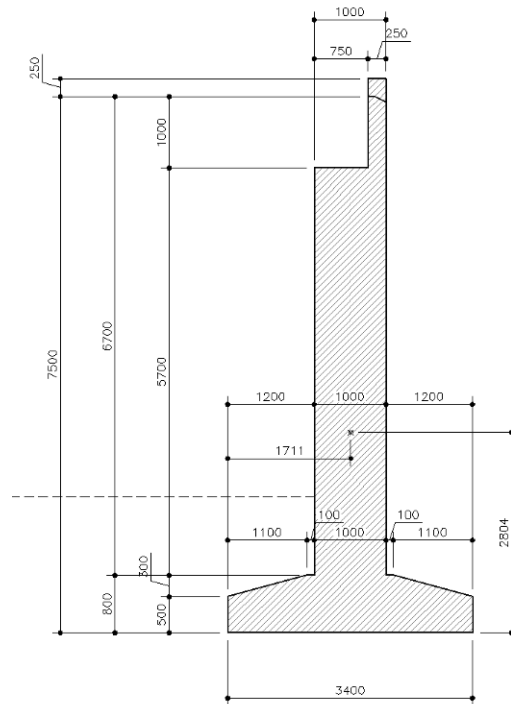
Geometria di calcolo spalla esistente
